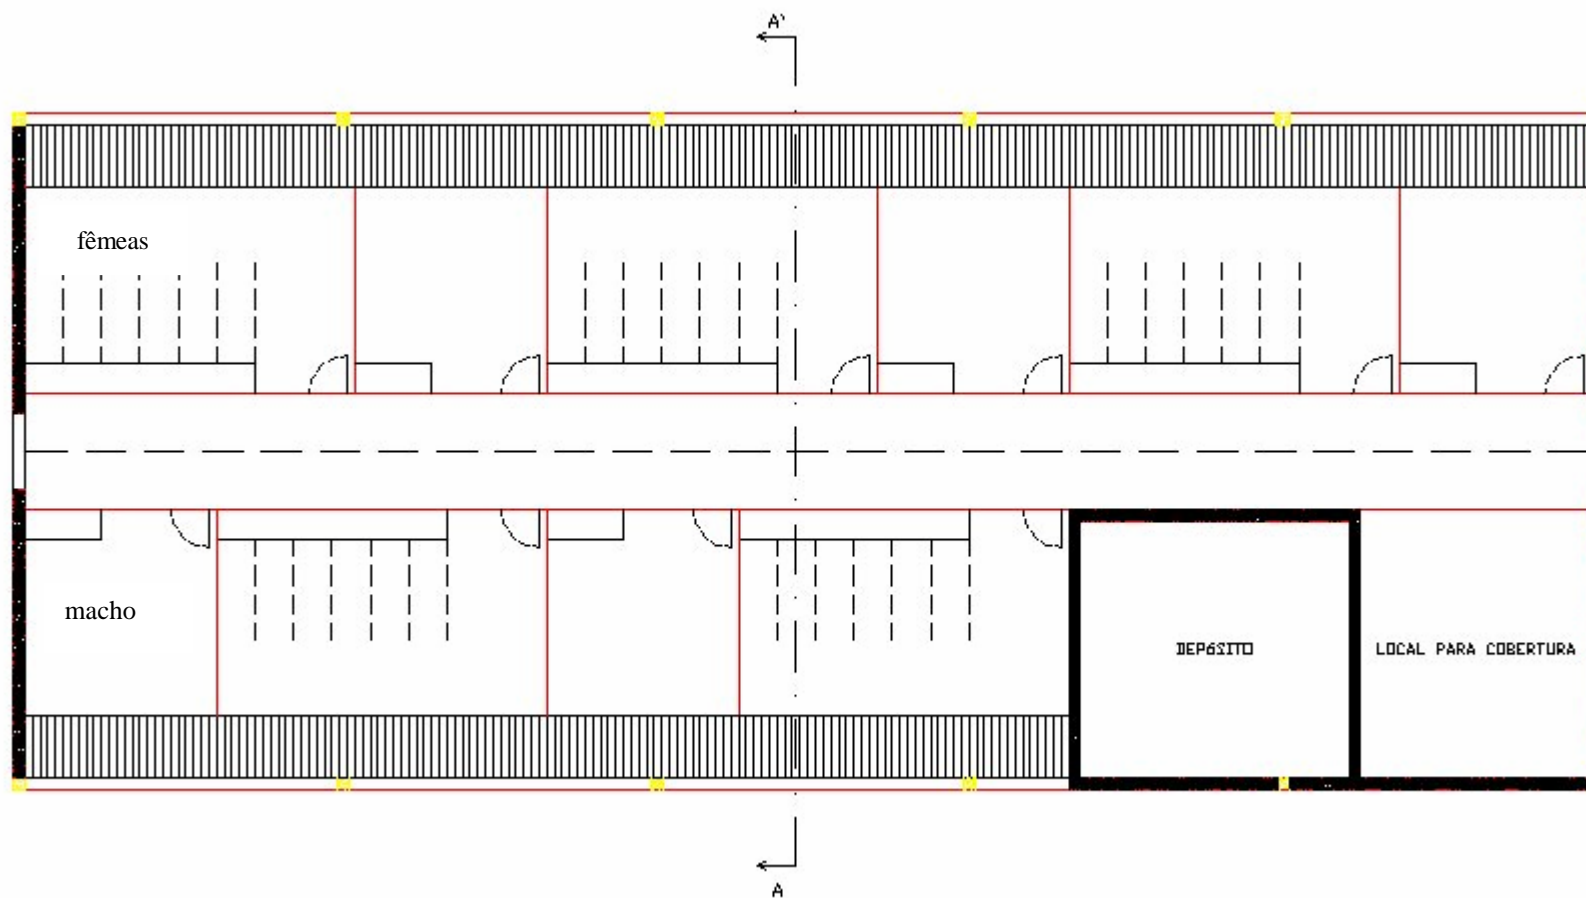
Esquema em planta baixa do prédio de pré-cobrição e cobrição.
